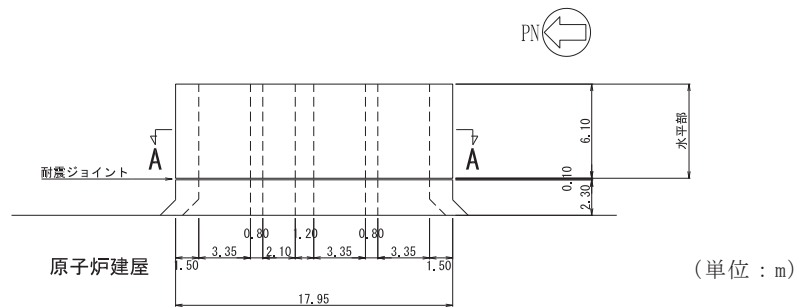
原子炉機器冷却海水配管ダクト平面図
